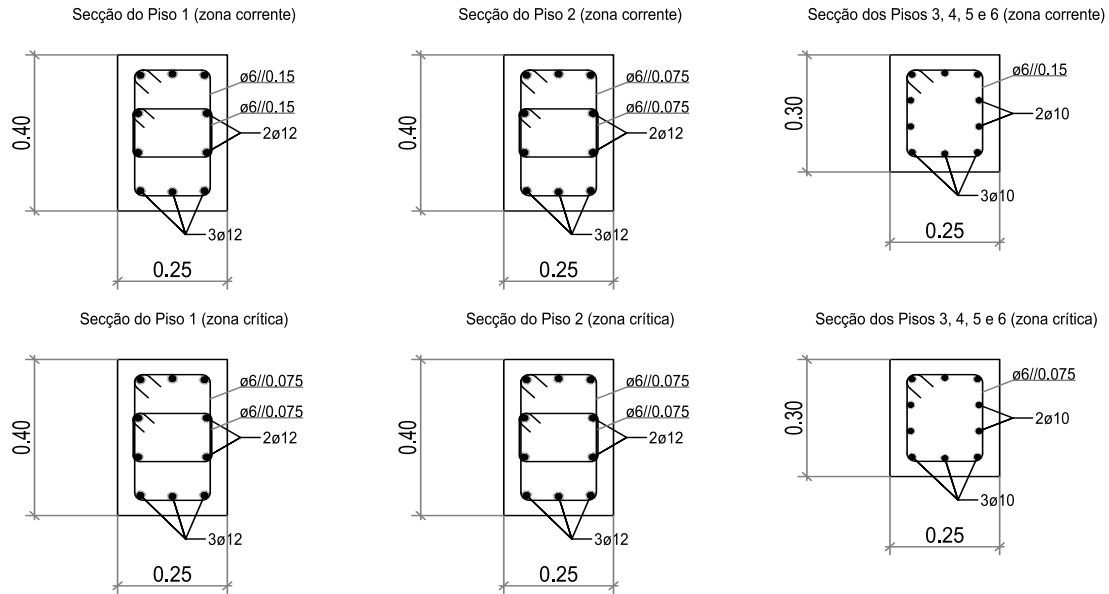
Edifício real e modificado: Secções de armadura do pilar de canto (P1)
